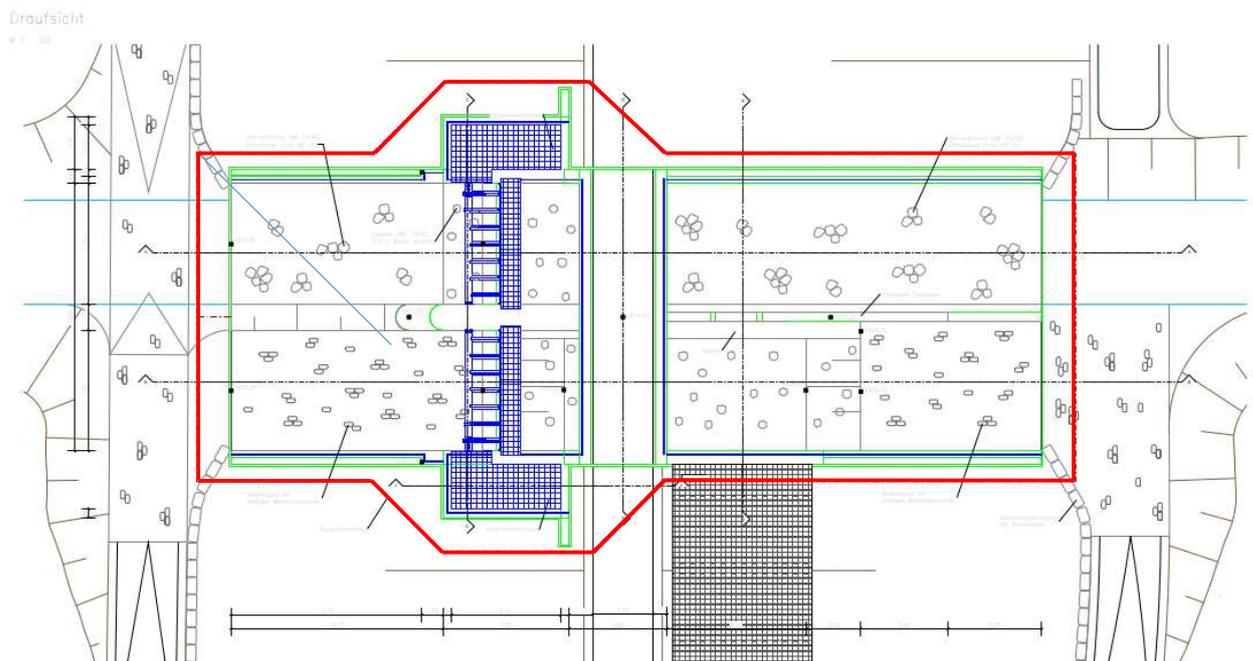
Draufsicht Durchlassbauwerk, welches zur Herstellung mit einem Baugrubenverbau umschlossen werden muss (Verbau rot skizziert).
